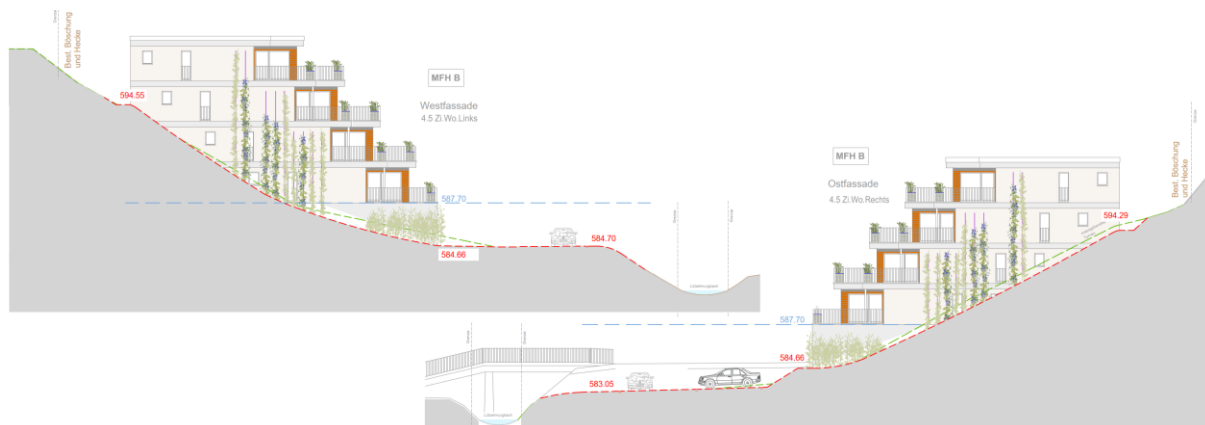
Ausschnitt des LA Richtprojekts, Fassadenansicht/Fassadenbepflanzung. PR Landschaftsarchitektur GmbH
